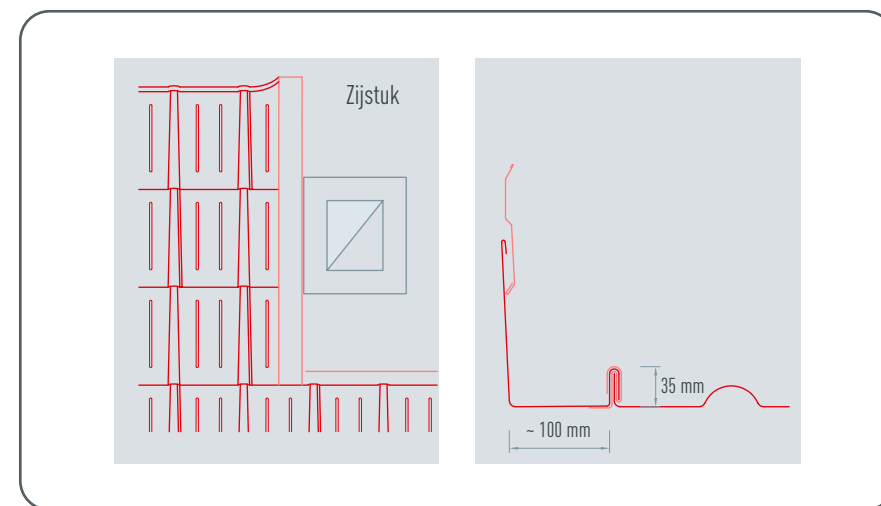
• Schoorsteenomlijsting – dakpan
